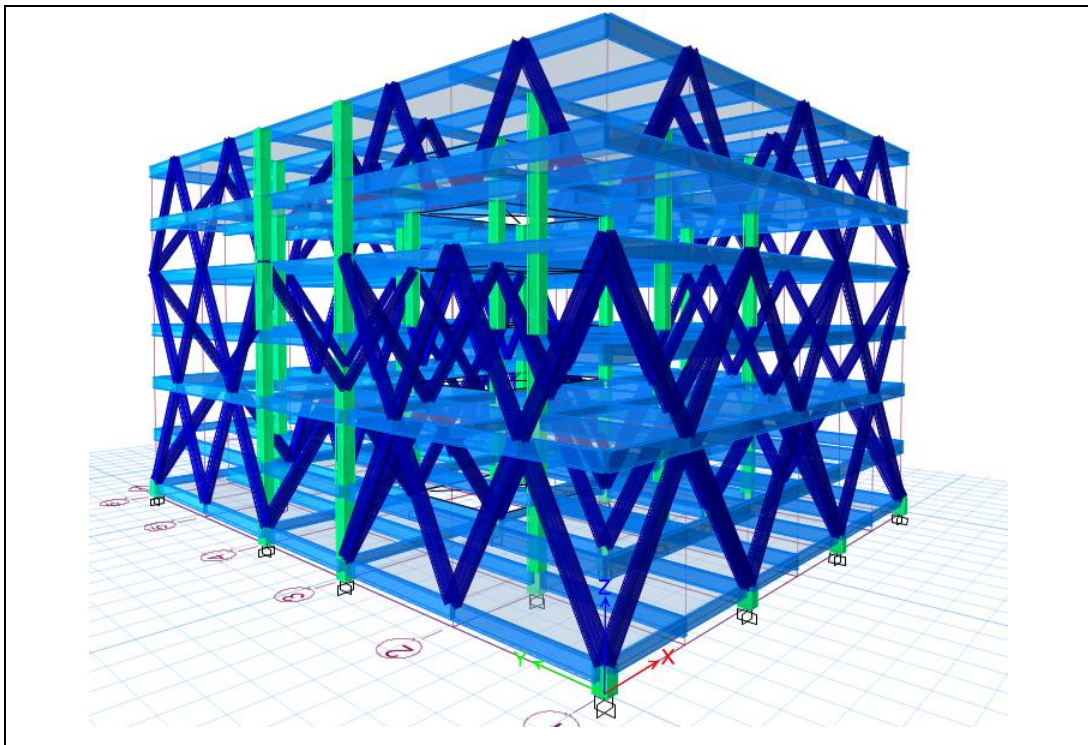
VISTA EN 3D, Diagrid con pórtico central
